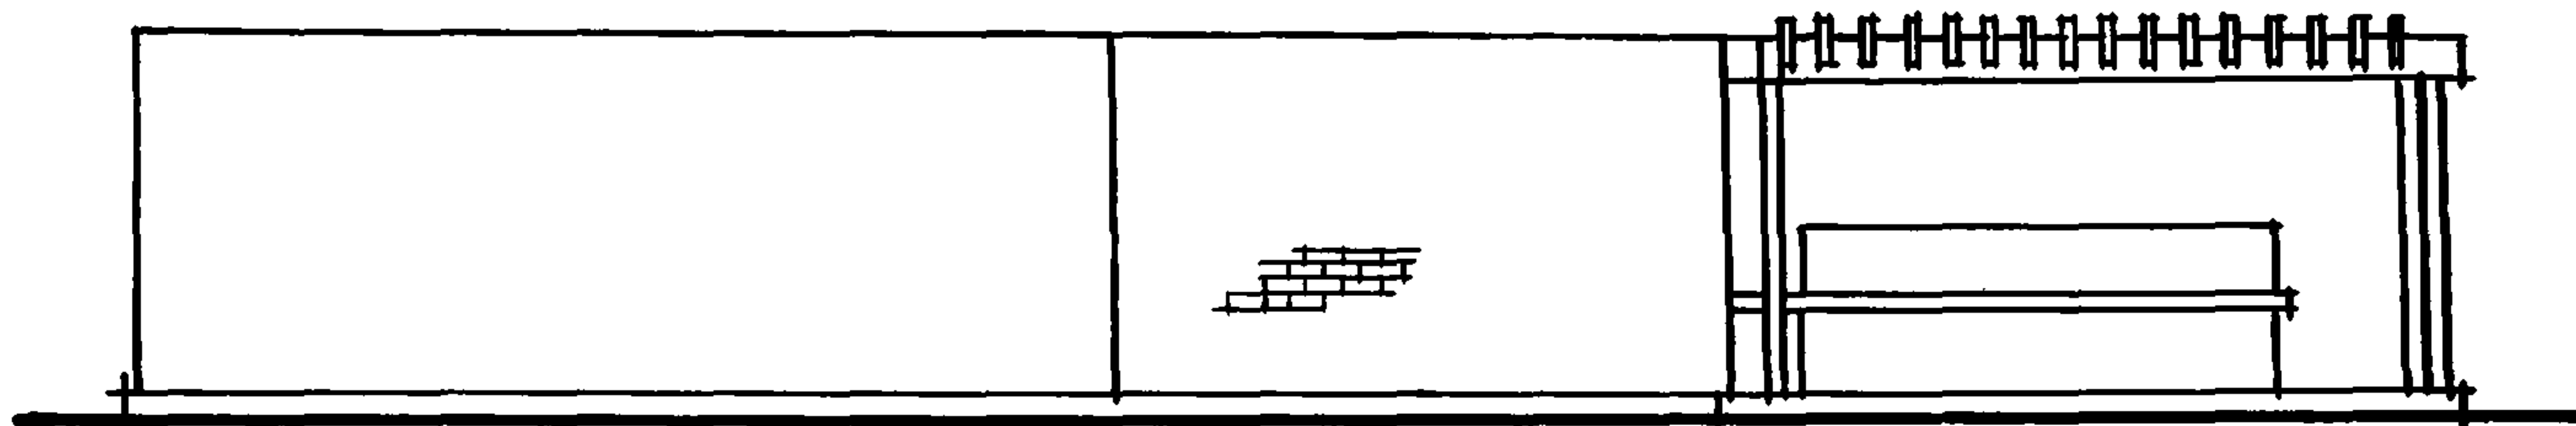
Фасад душевой на 17 сеток в осях 1-4
